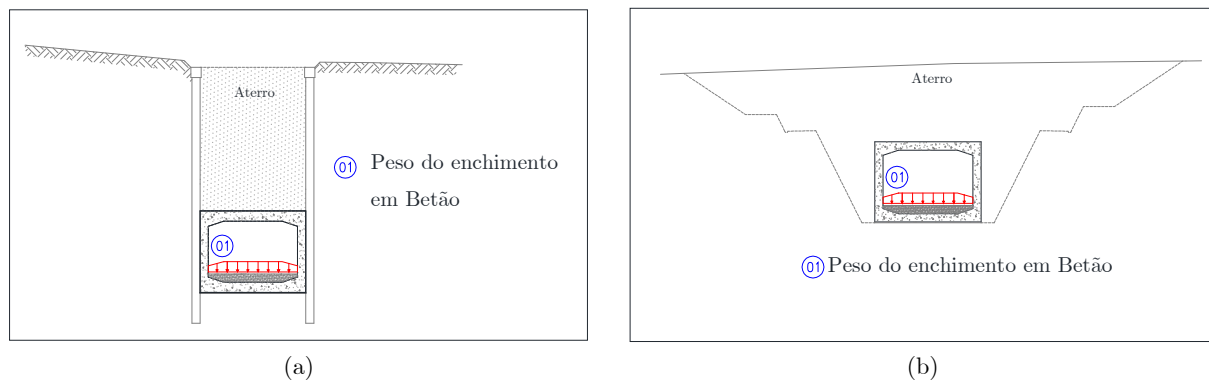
Peso do enchimento em betão sobre a laje de soleira (a) Troço 72; (b) Troço 74.
